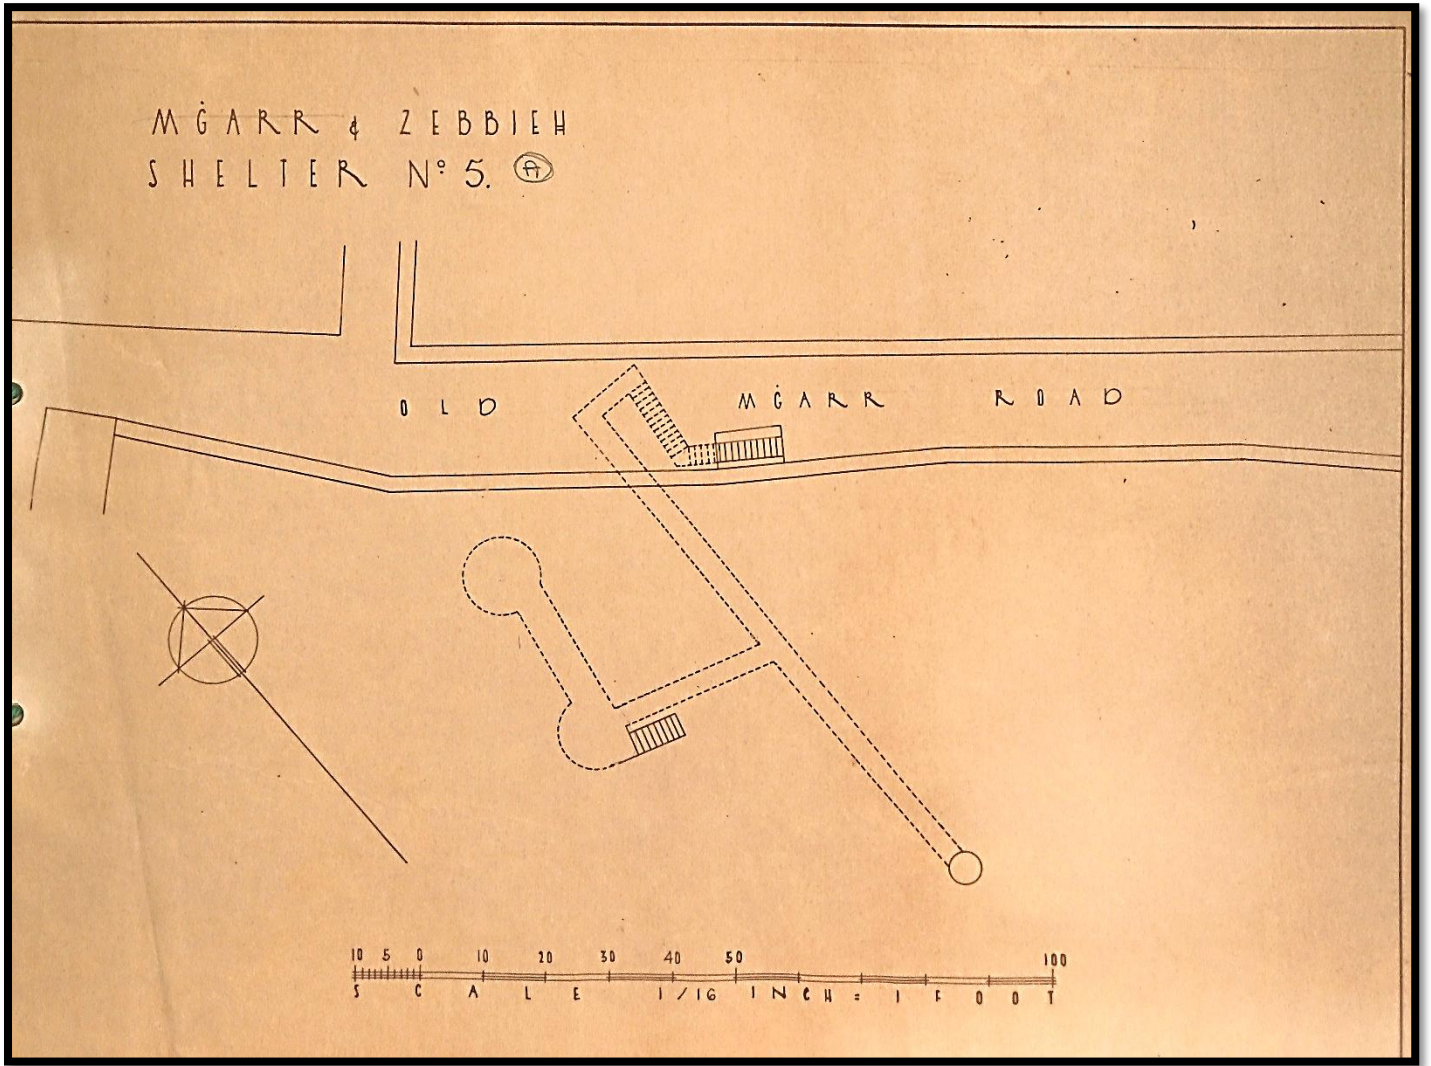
Planta do Abrigo nº5A "Old Mġarr Road."
